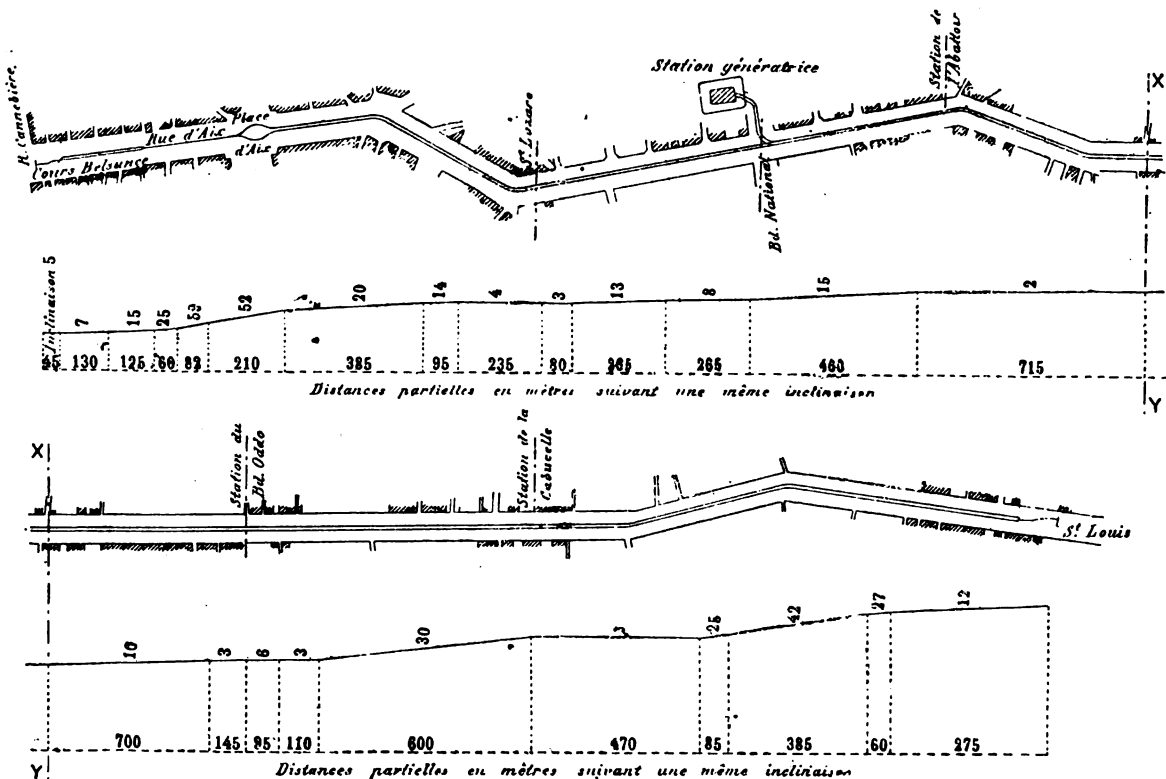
Pianta e profilo longitudinale della tramvia Belsunce-San Luigi.
